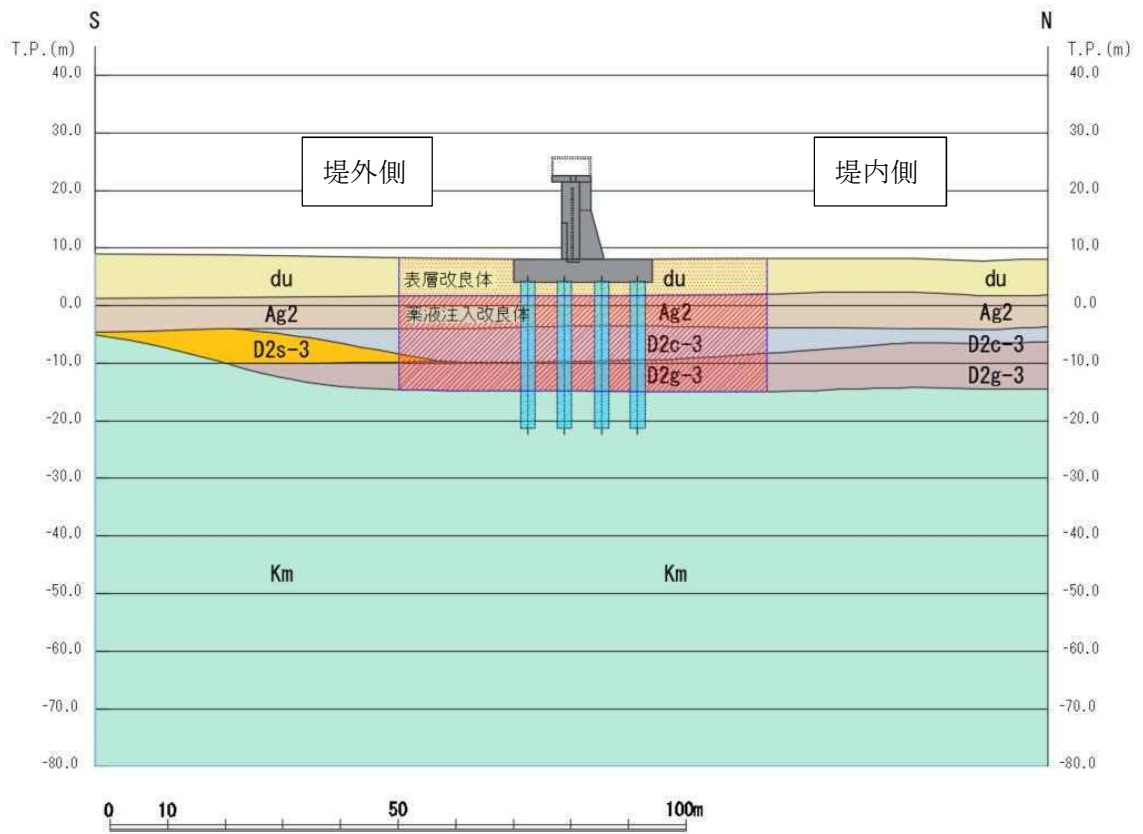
(1) 評価対象断面図 (A-A断面)
